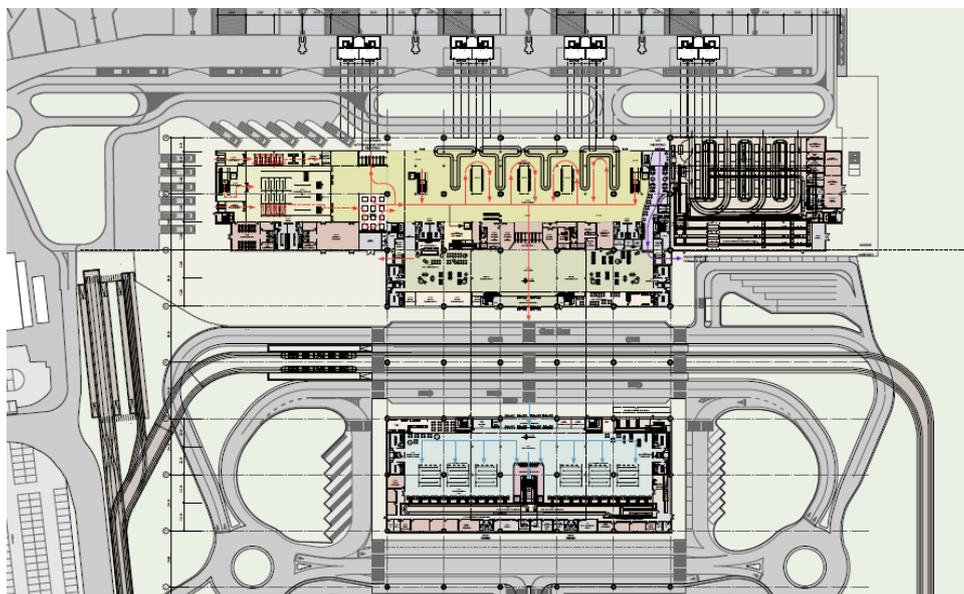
| Planimetria Piano Terra Terminal Anno 2026
